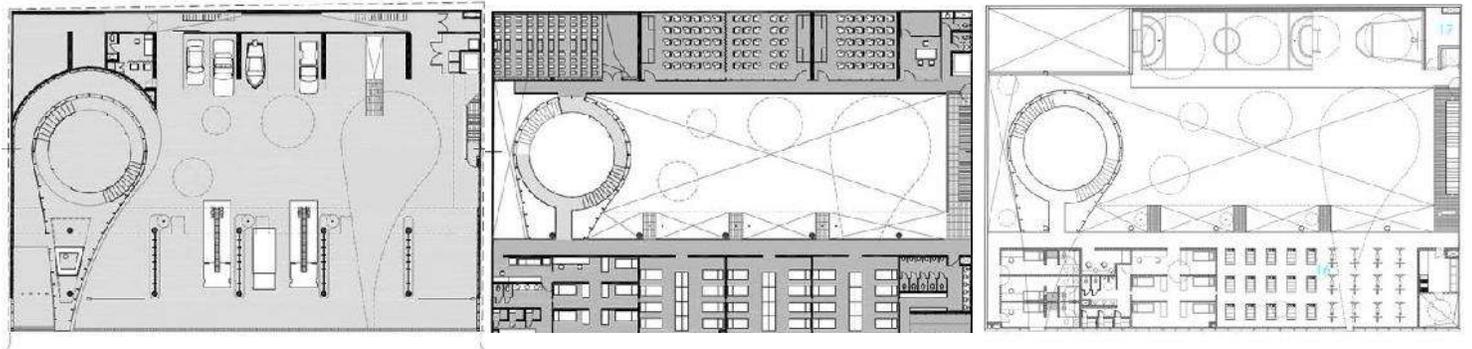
, 20, 21: Plantas arquitectónicas de la Estación de Bomberos Ave Fénix.
